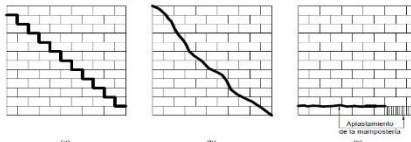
Modos de falla de la mampostería no reforzada sometida a cargas en su plano.
